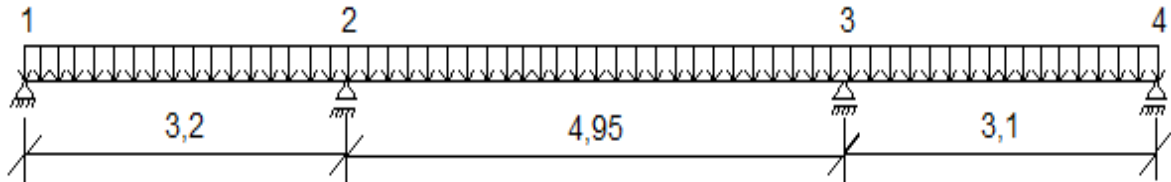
Schéma statique d'une poutre simplement appuyée.
